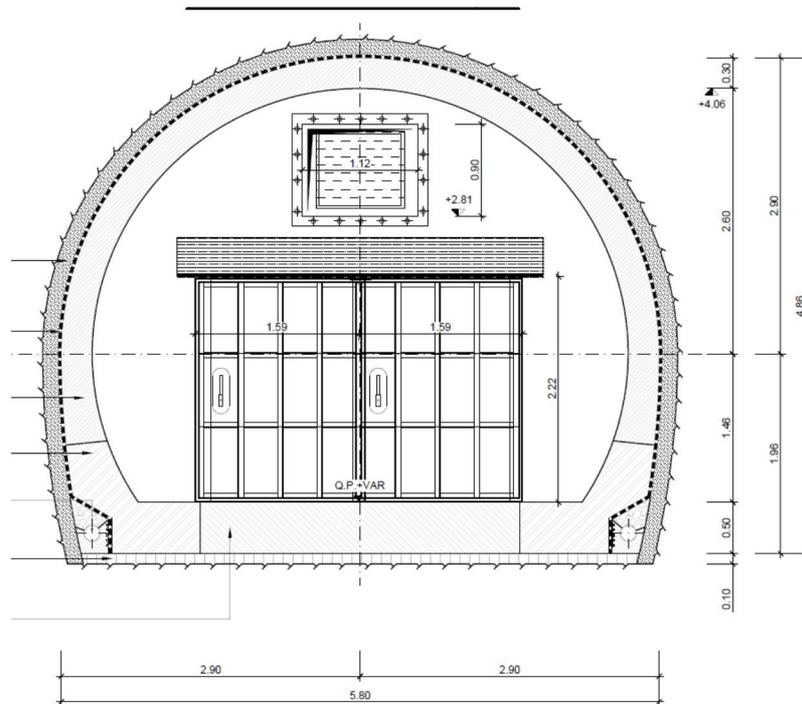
Ramo di collegamento e per i servizi di soccorso: sezione di giunzione [27]
